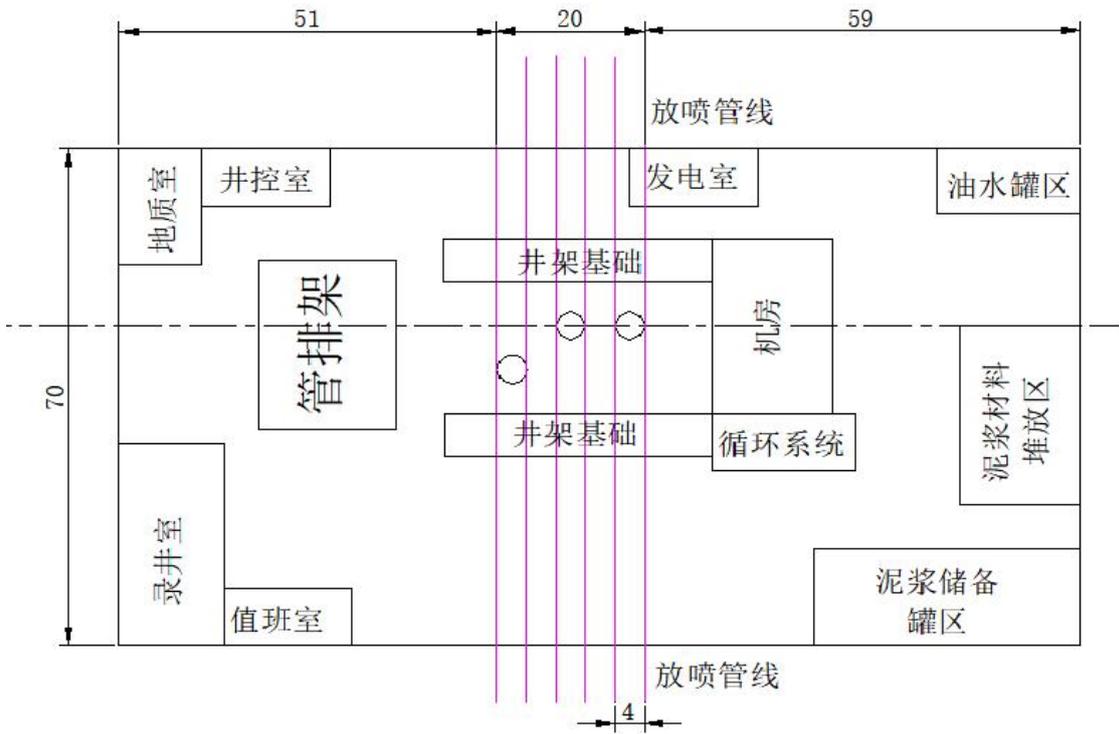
L 字型三丛井井场施工平面示意图 (单位: m)
